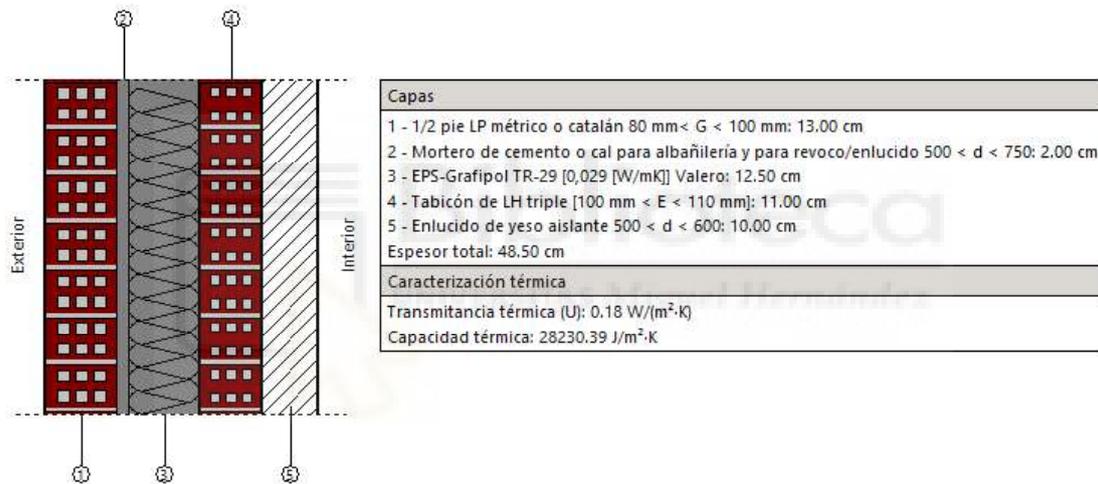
Capas de la Fachada exterior Zona climática E. CYPETHERM HE Plus
